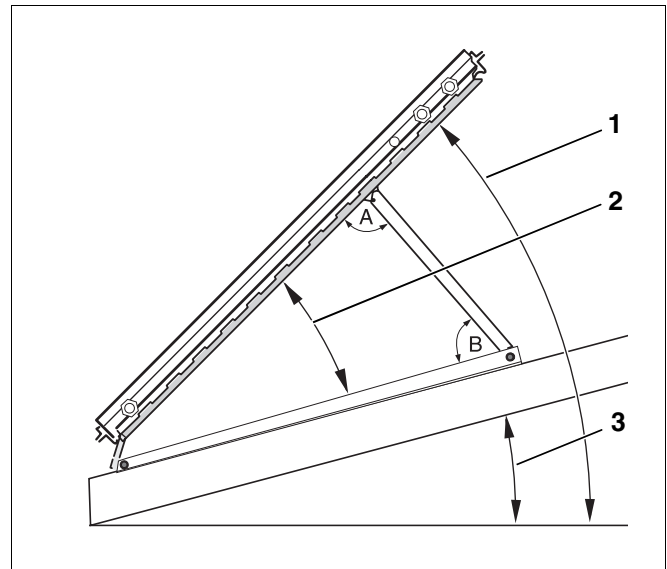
Neigungswinkel, Anstellwinkel, Dachneigung
